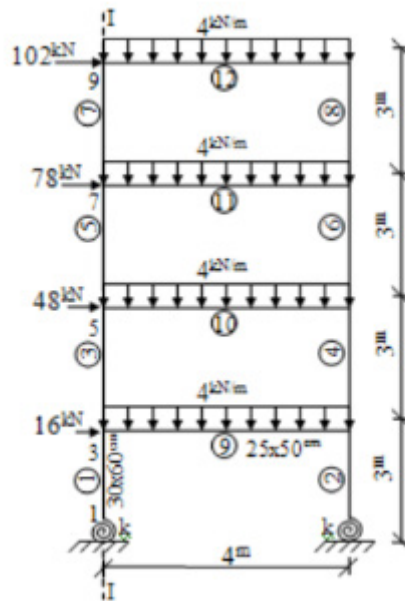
Расчетная схема рамы с поворотными пружинами в опорных узлах
